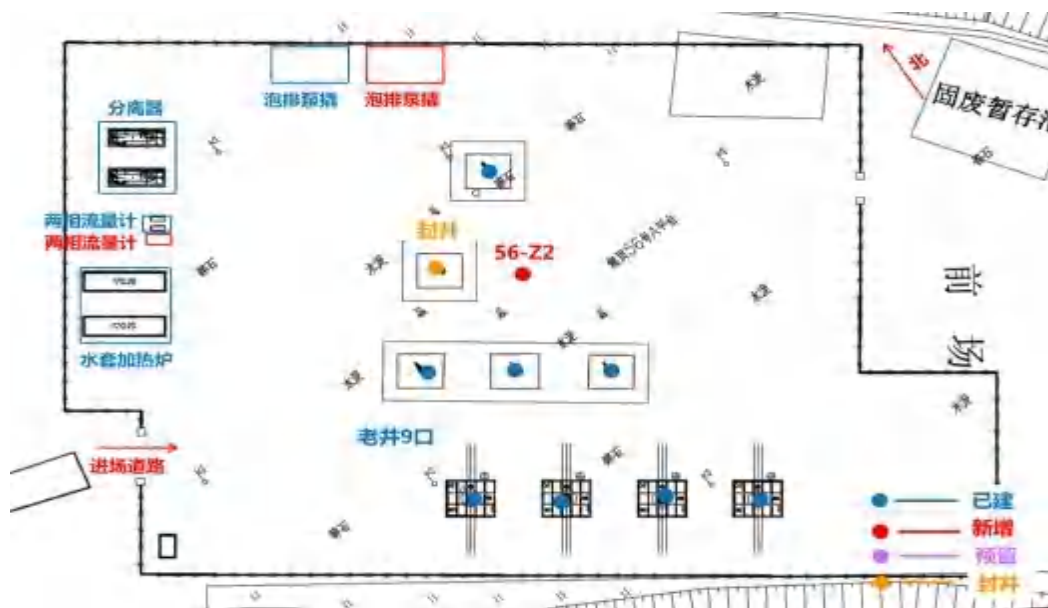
焦页 56 号 A 平台扩建后平面布置图
